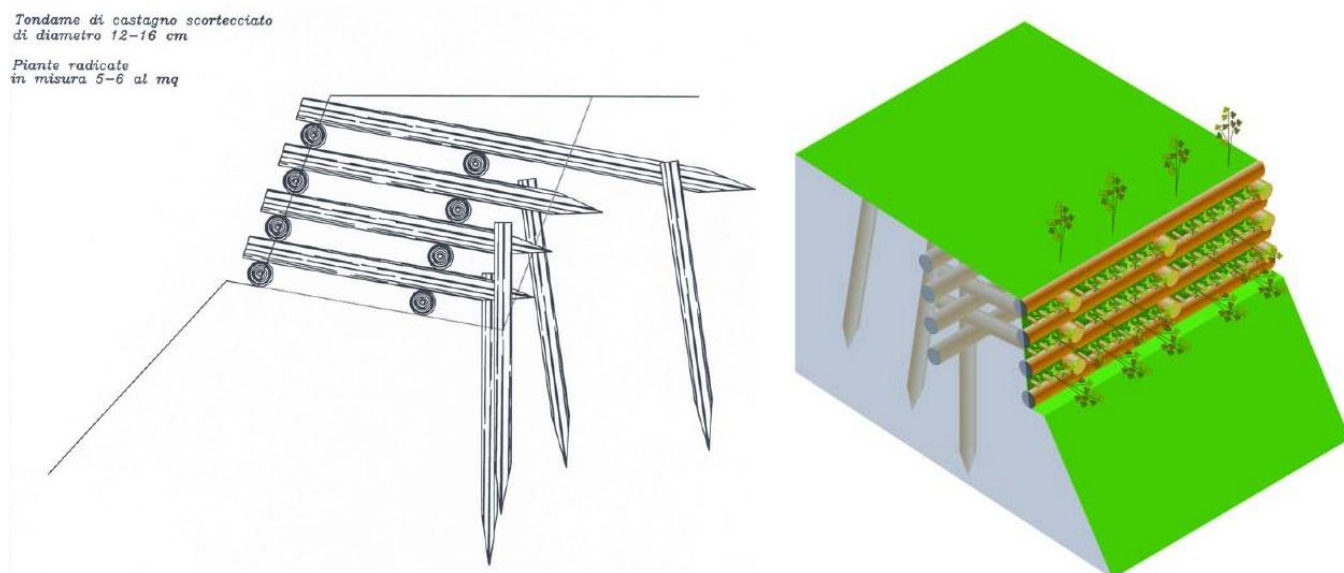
Sezione (a sinistra) e assonometria della sistemazione finale (a destra) di una palificata a doppia parete Vesuvio sec. Menegazzi.
